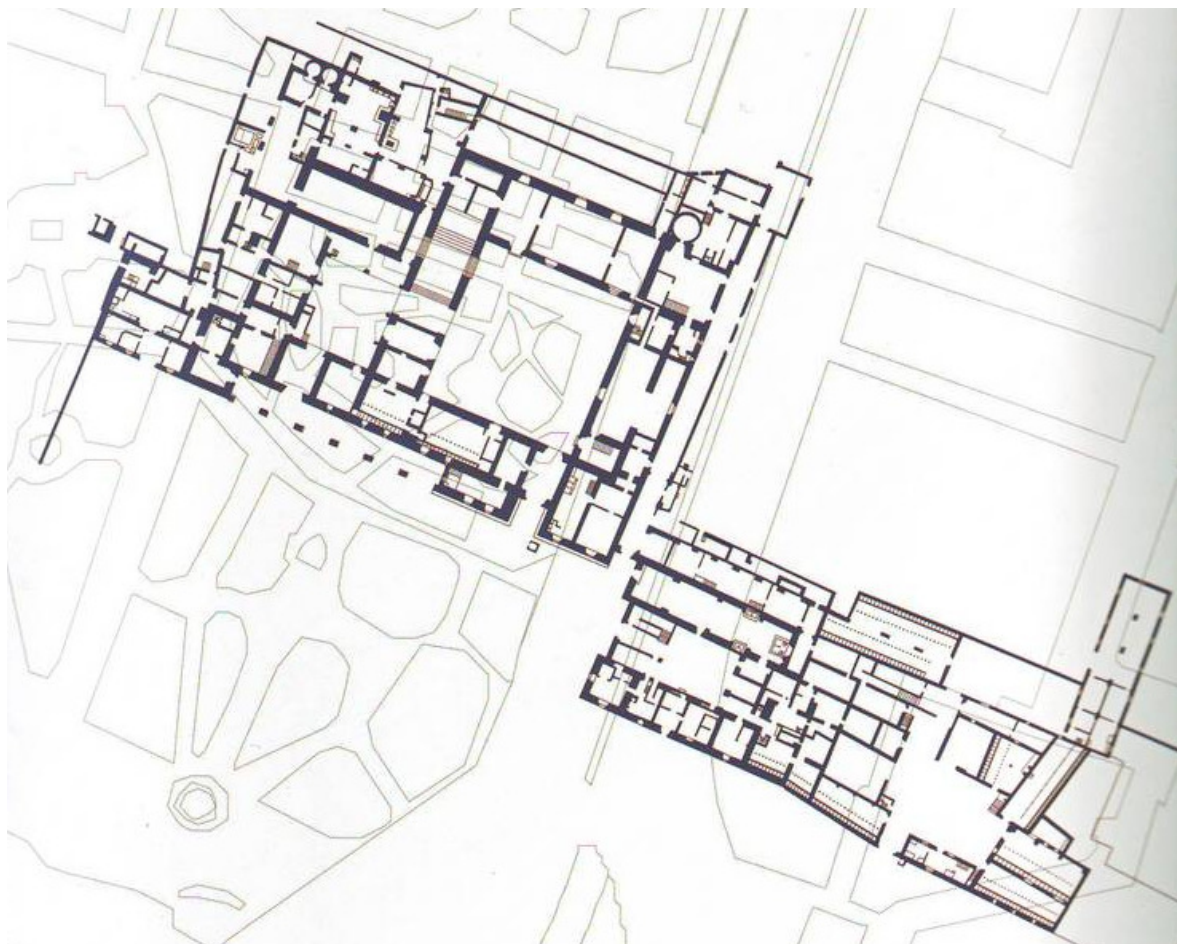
, Plano planta sobre la cartografía actual de fondo.
